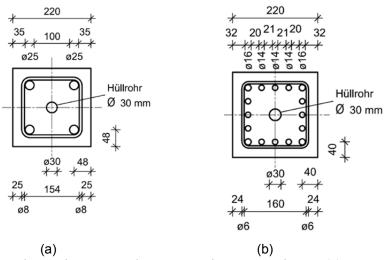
Querschnitte der Diagonalen mit Bewehrungsanordnung; (a) Diagonale - Bewehrung in den Ecken (b) Diagonale - Bewehrung umfangsverteilt (Maße in mm) (Biadatz 2017)
